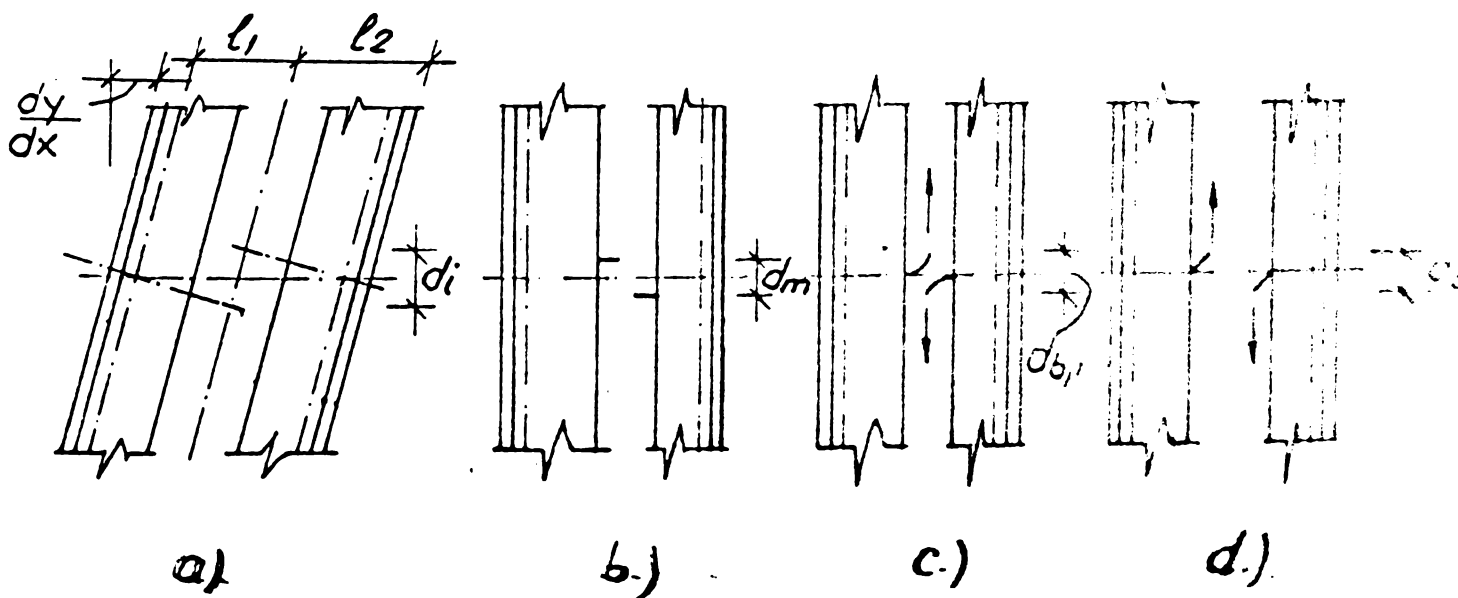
Deplasările lamelelor la mijlocul deschiderilor
